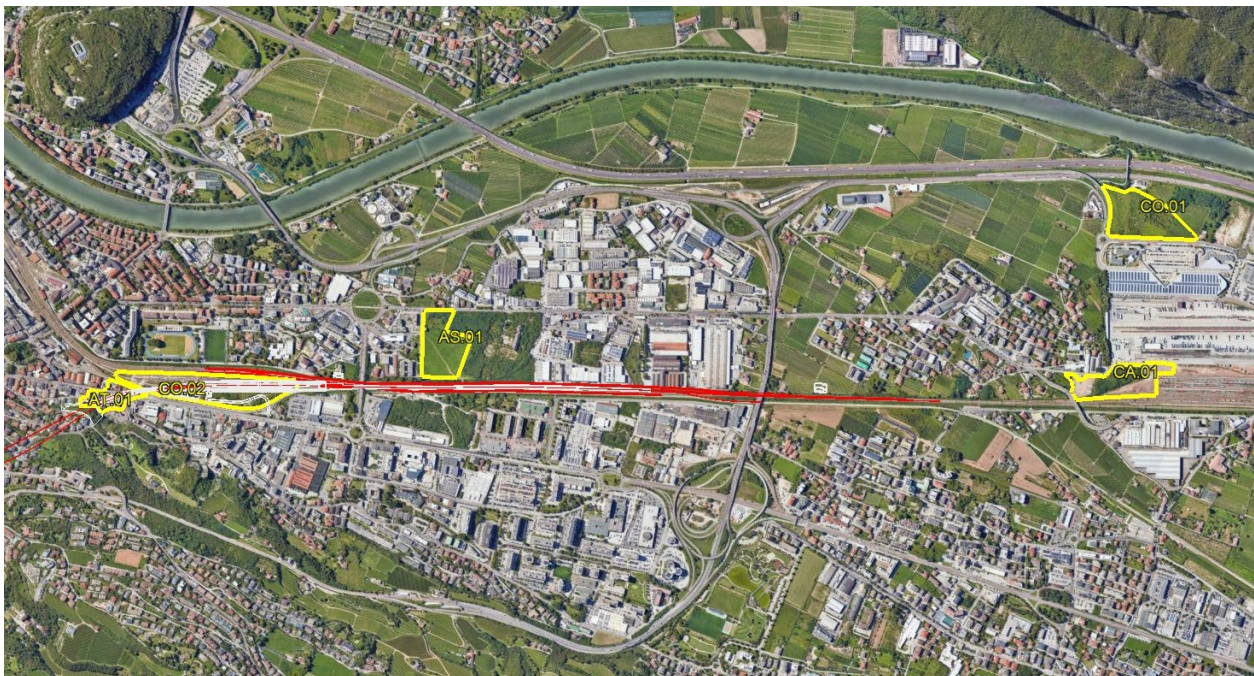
Aree cantiere fronte nord Galleria Trento
